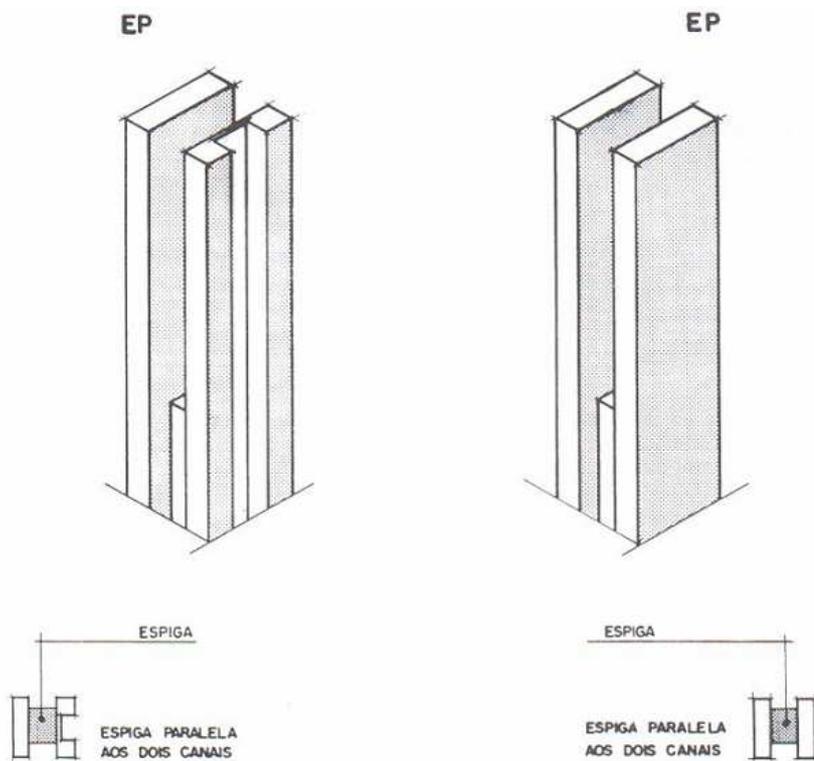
Casema (1998) - Espiga para montante 3 canais/Montante paralelo (paralela aos 2 canais).
